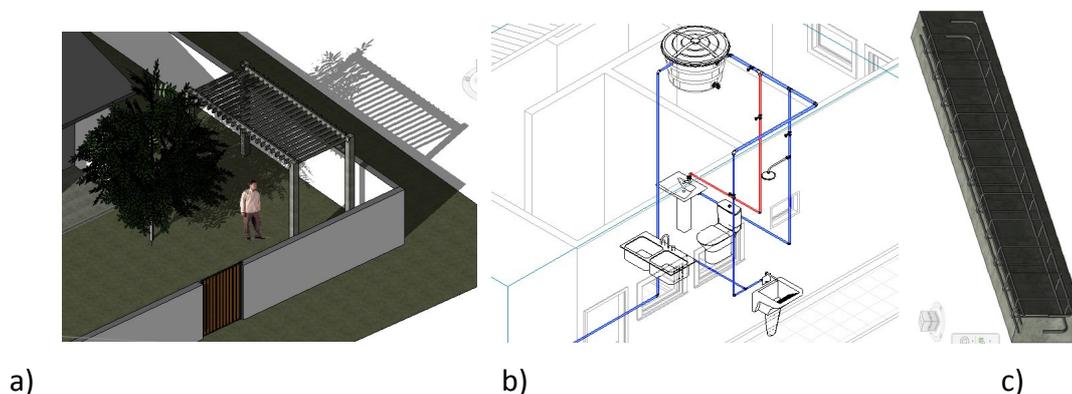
Modelagens com o Autodesk Revit - a) Sombreamentos; b) Projeto hidráulico; c) Concreto Armado.
